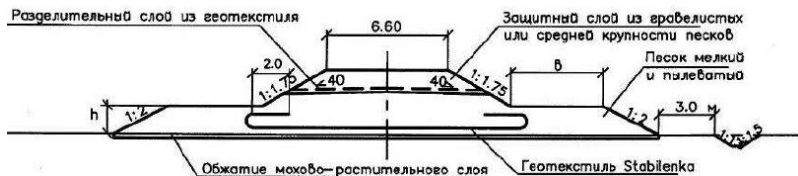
Насыпь высотой от 2м до 6м на слабых грунтах
